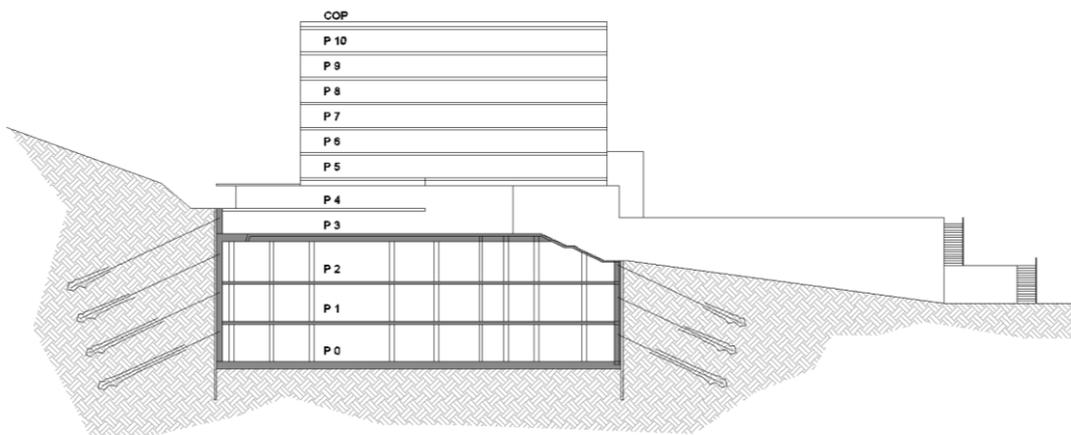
SEZIONE TRASVERSALE SCHEMATICA
